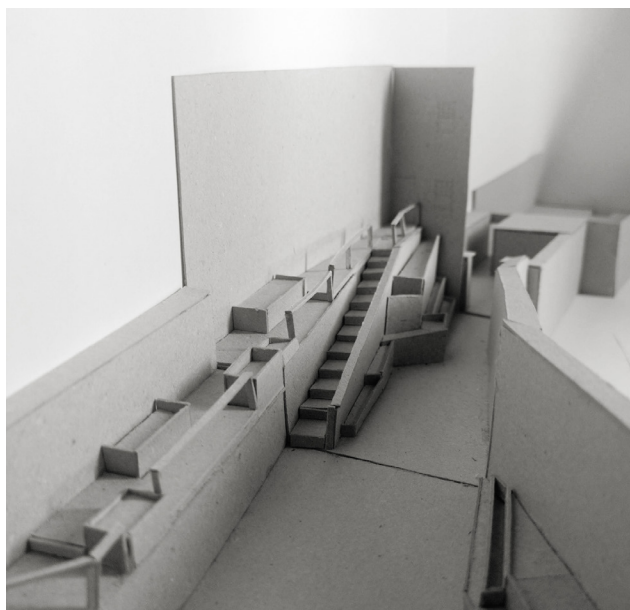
Construção da maquete: Zona das escadas e piso superior.
